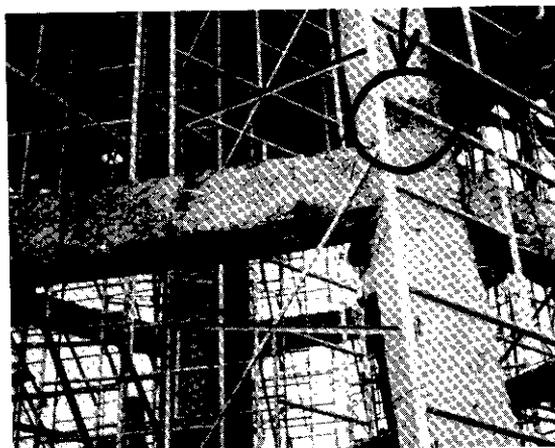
Vista de viga e pilar na altura do 2.º anel. Este Pilar foi encamisado no trecho assinalado.
